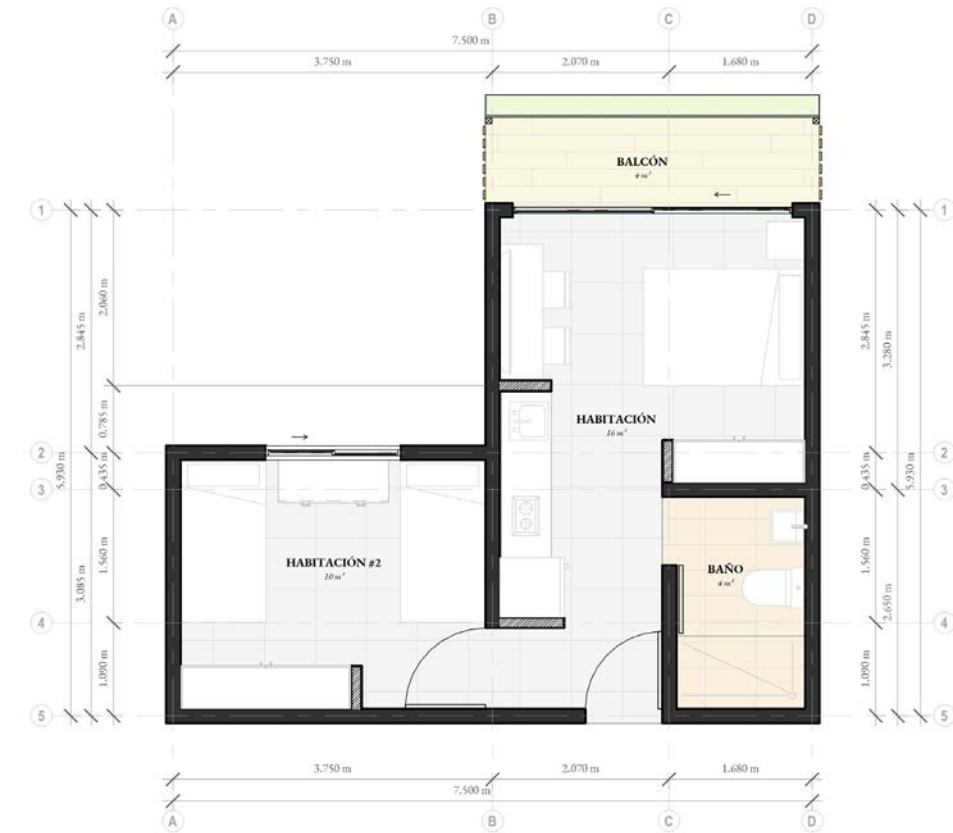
Planta de distribución arquitectónica ampliada tipología de cuartería de dos dormitorios. Fuente: Cambronero, V., Rodríguez, N. (2023)
